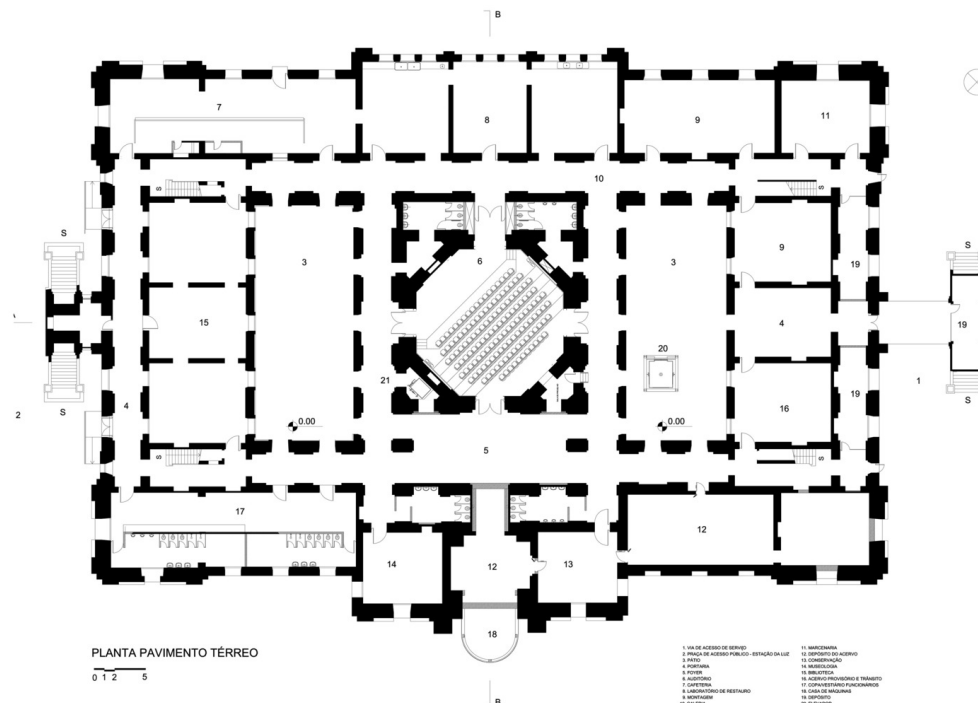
Planta do pavimento térreo do edifício da Pinacoteca do Estado. Fonte: <https://www.archdaily.com.br/br/787997/pinacoteca-do-estado-de-sao-paulo-paulo-mendes-da-rocha>, acesso em 10 de outubro de 2018.
